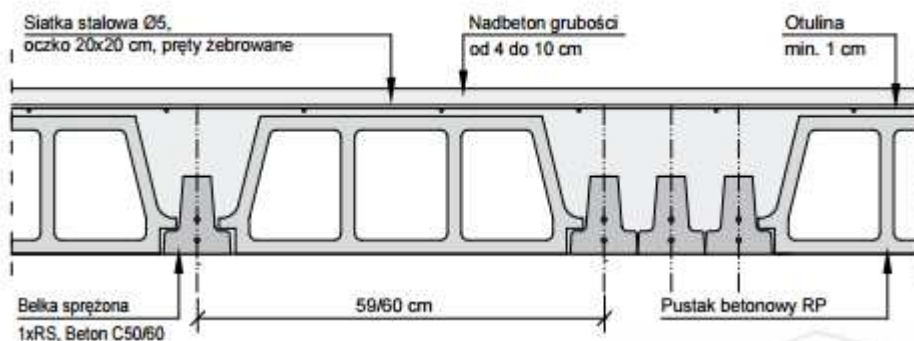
Przekrój przez belki RS 112 i RS 114.
